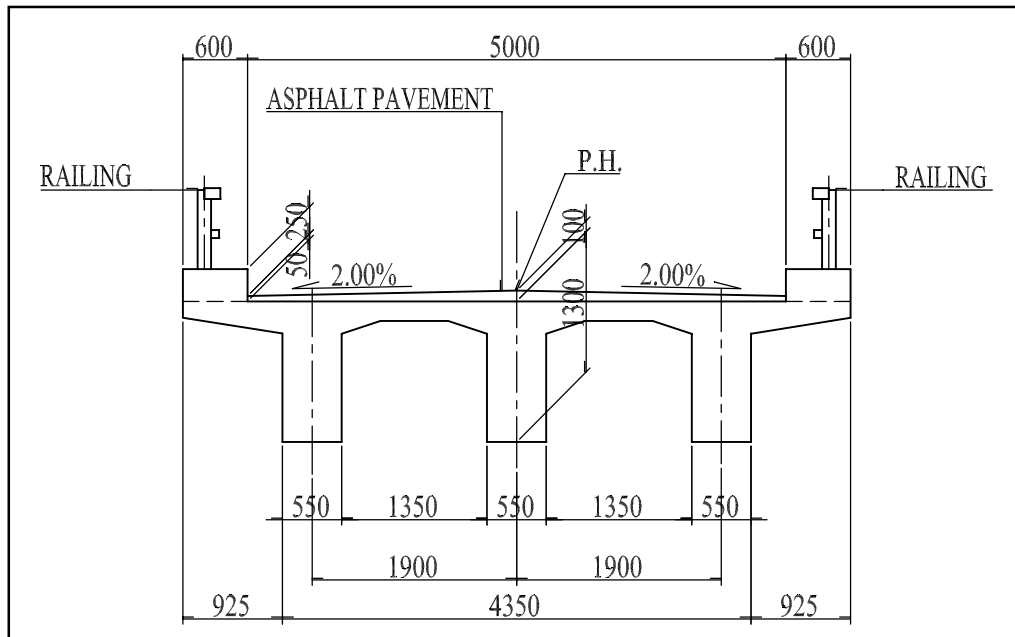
桥梁标准横断面图 (Bridge No.1 & No.2)
